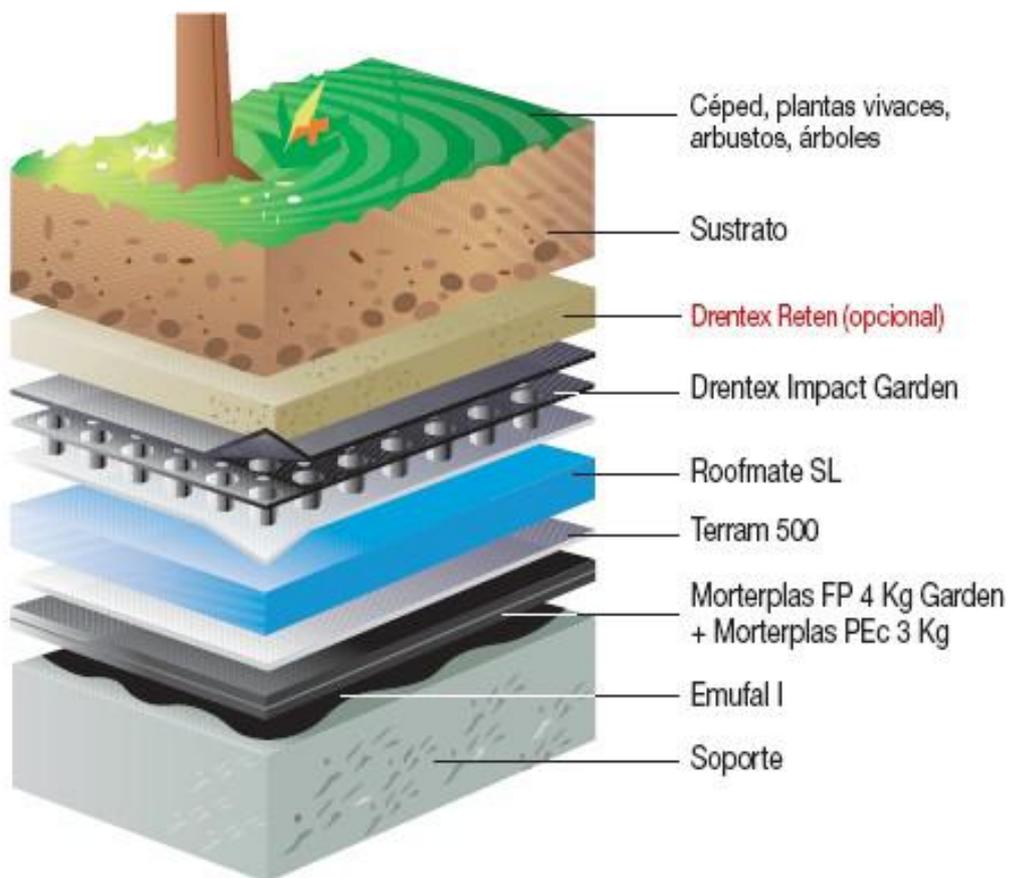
Ilustração camadas de Telhado Verde Leve Fonte: Greentex –
